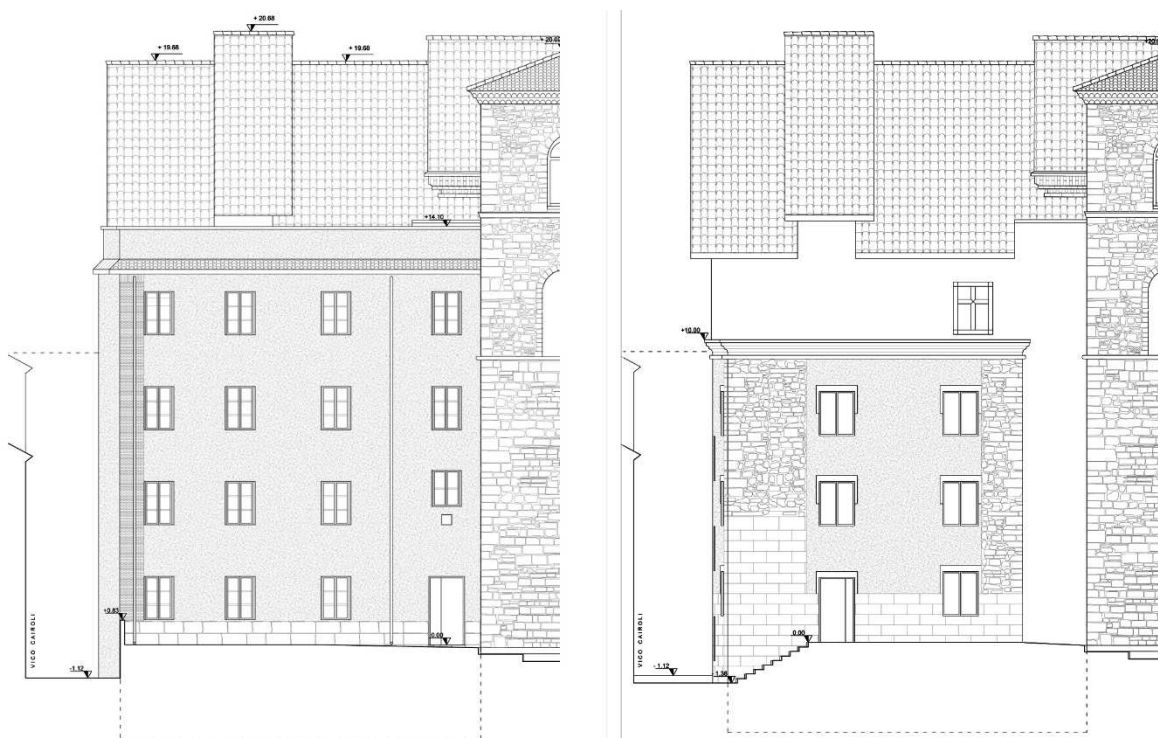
Confronto tra il prospetto principale dello stato di fatto e quello di progetto
